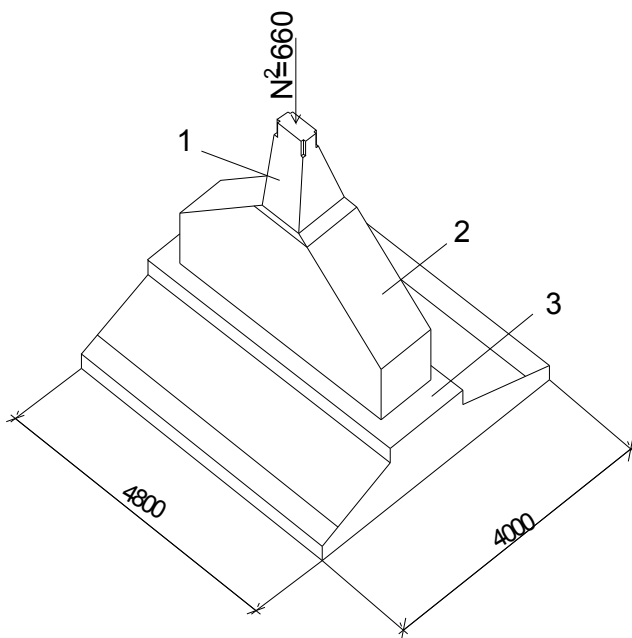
Сборный столбчатый фундамент под колонны каркасных зданий:
